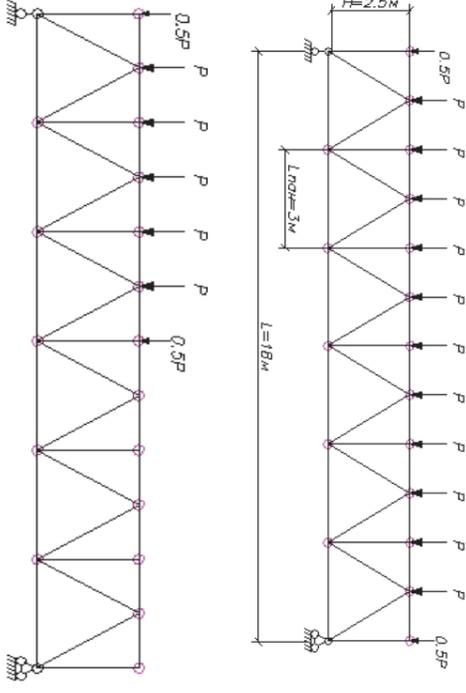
Схема фермы: а – первый вариант нагружения;
